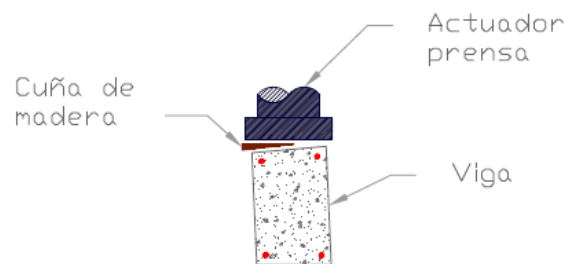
Uso de cuñas de madera en la viga 1 y 2 para estabilizar la carga.
